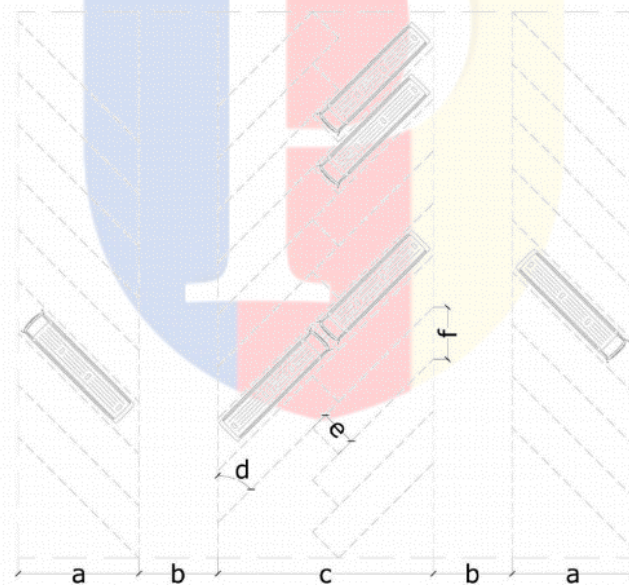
Ruang Parkir yang Terpisah dengan Sirkulasi Terminal (1)
